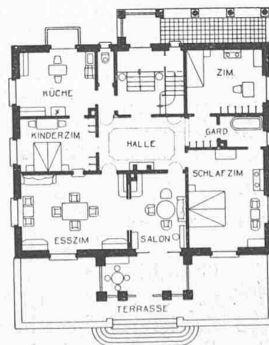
und 2. Grundrisse vom Hause Hirt-Suter. — 1:400.
